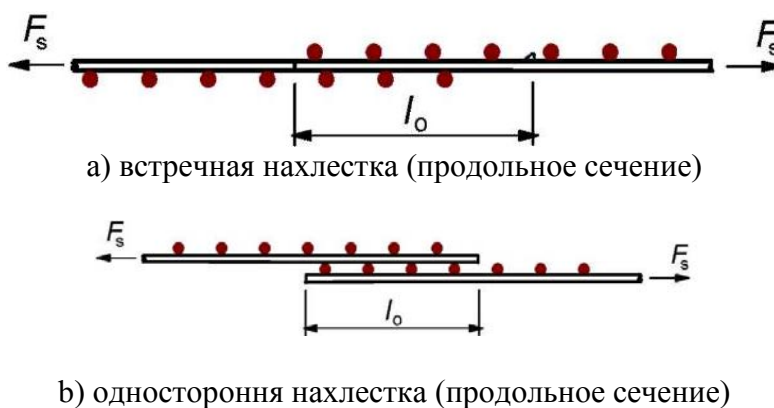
Соединения сварных сеток внахлестку
